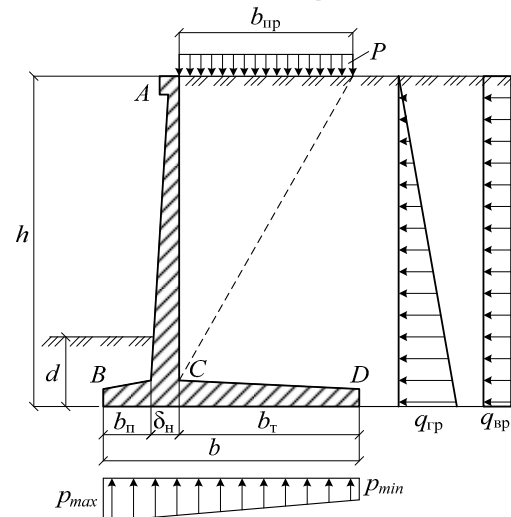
Схема нагрузок на стенку без учета ее совместной работы с грунтом
